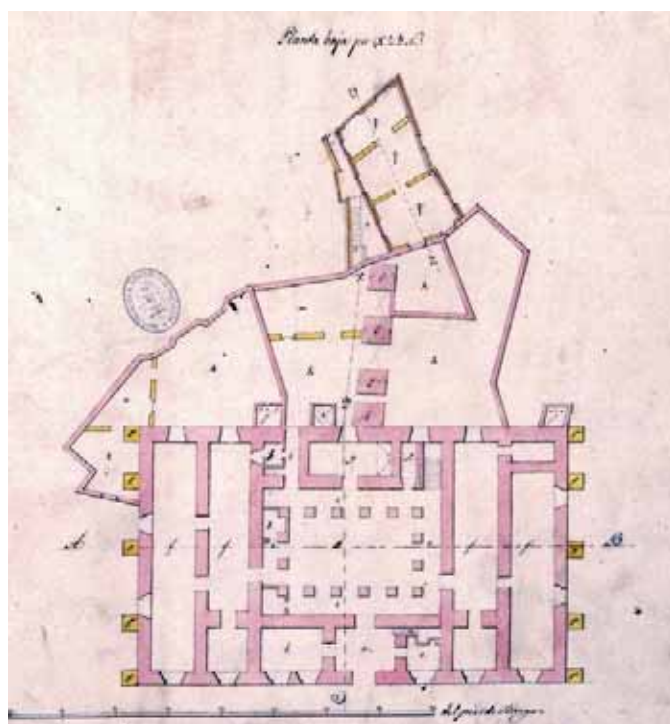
Planta baja del Plano del Hospital Militar y Civil de la Plaza de Melilla, 1849. IHCM. Cartoteca. N° 4.689, C-32-15/MEL-G2/17.
